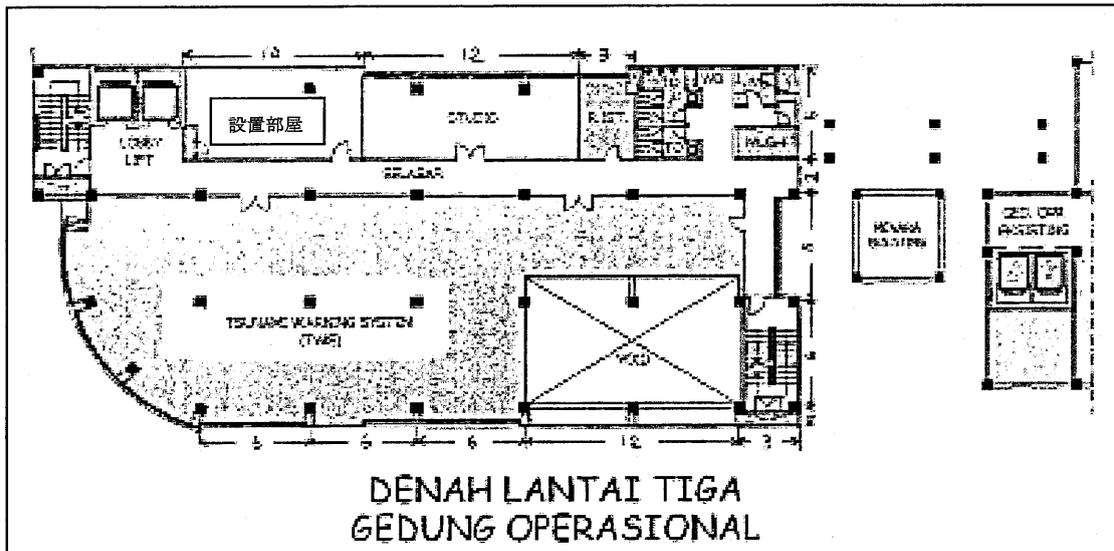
5 DENAH LANTAI TIGA GEDUNG OPERASIONAL
